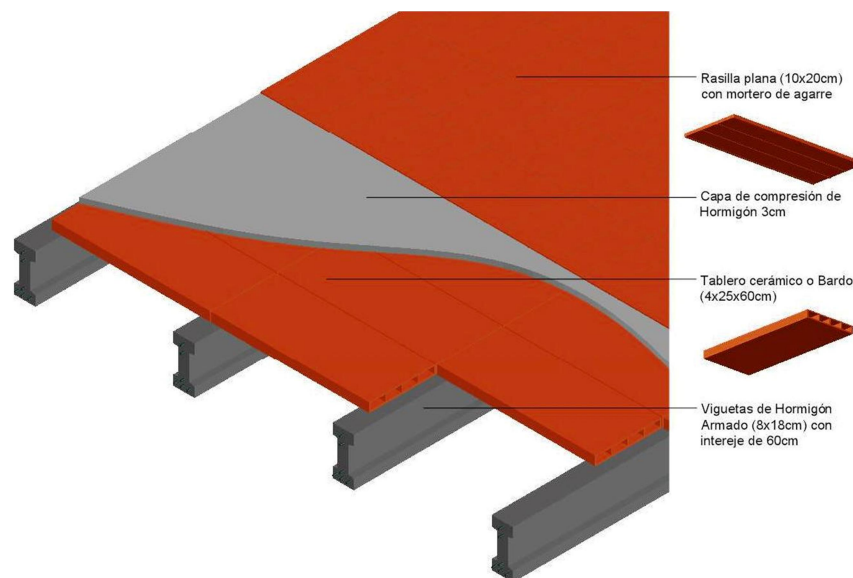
Detalle de forjado de tablero cerámico o bardos con capa de compresión, sobre viguetas prefabricadas de hormigón armado
